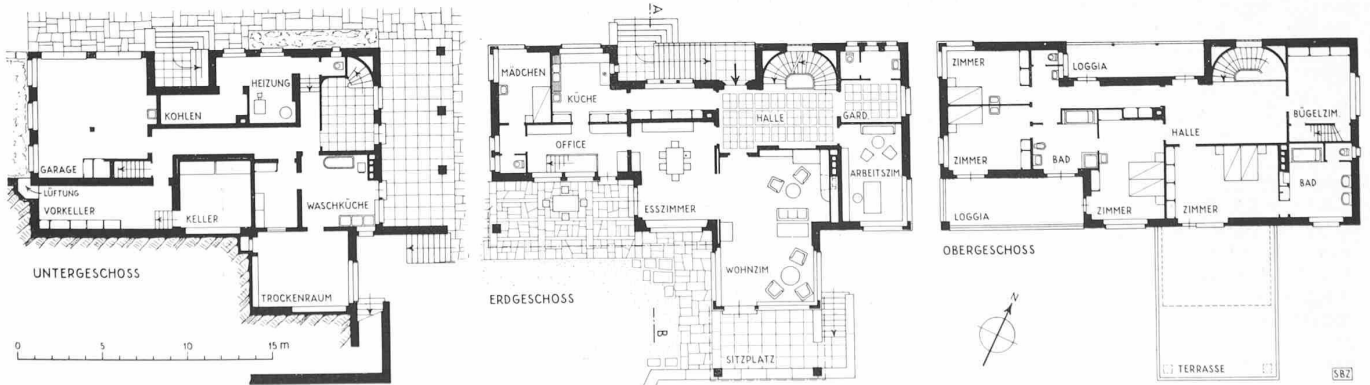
und 6. Grundrisse und Schnitt A-B, 1 : 400, der Casa San Giorgio ob Ascona. — Arch. SCHERRER & MEYER, Schaffhausen
